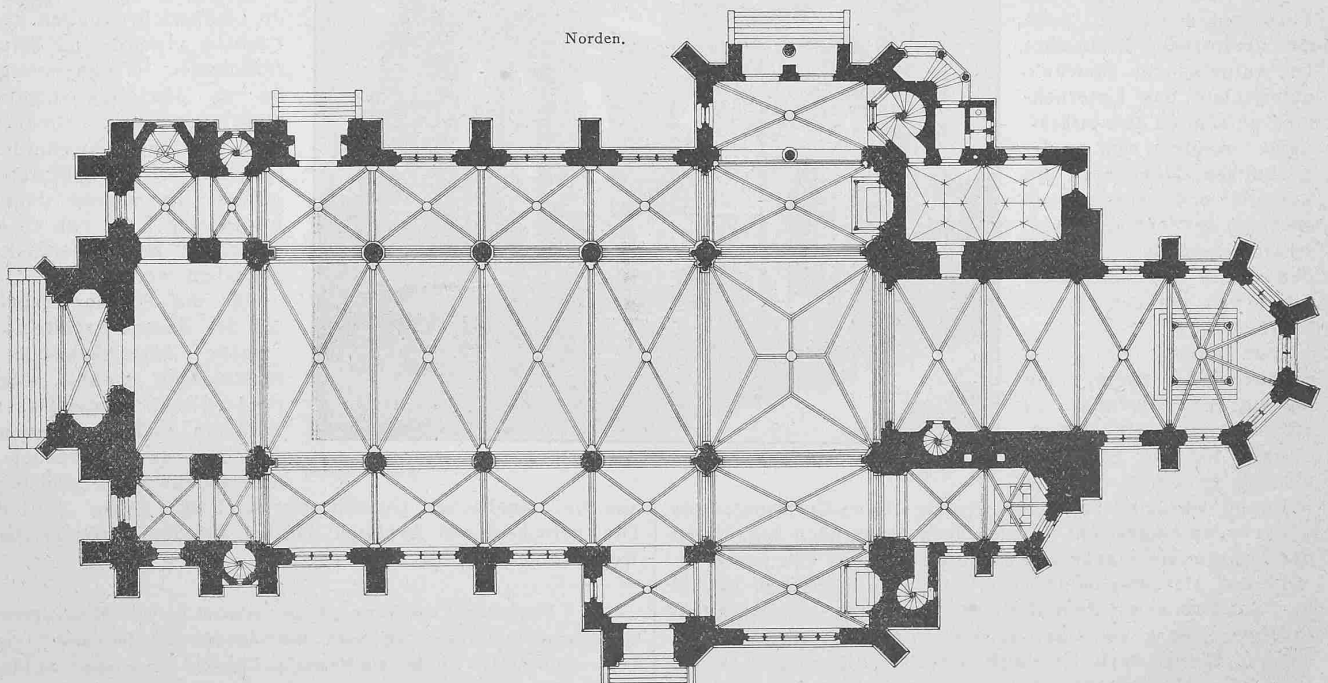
Grundriss. — Masstab 1:450.
